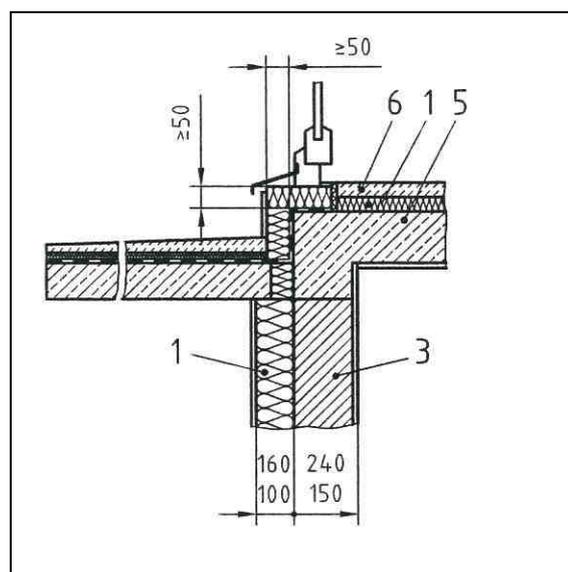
Fenstertür, außengedämmtes Mauerwerk, Anschluss Balkonplatte
